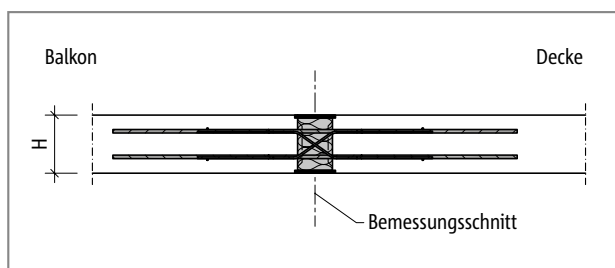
Schöck Isokorb® XT Typ DL: Statisches System
